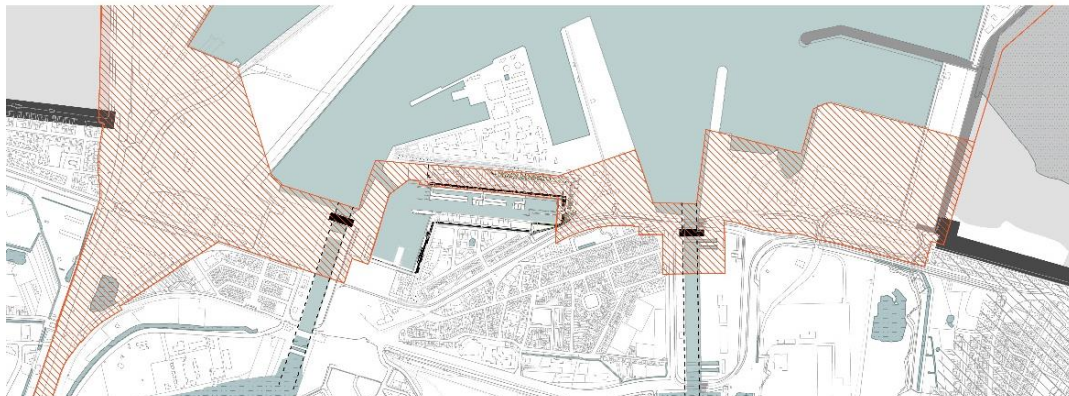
Alternatief Open havenmond + sluis jachthaven in Zeebrugge
